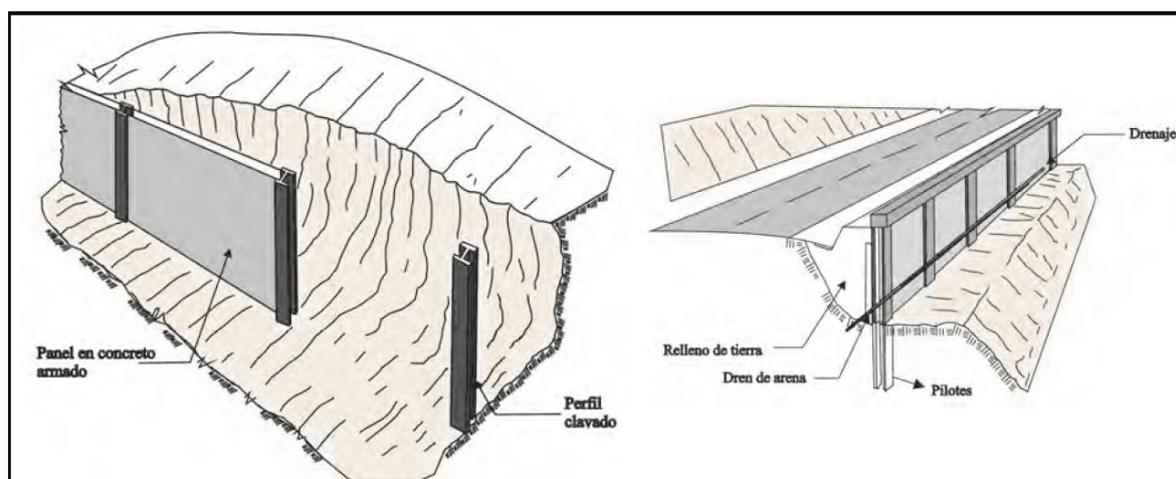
Ejemplo de muros de pantalla y muros con pilotes, (Vilchez, 2021)
